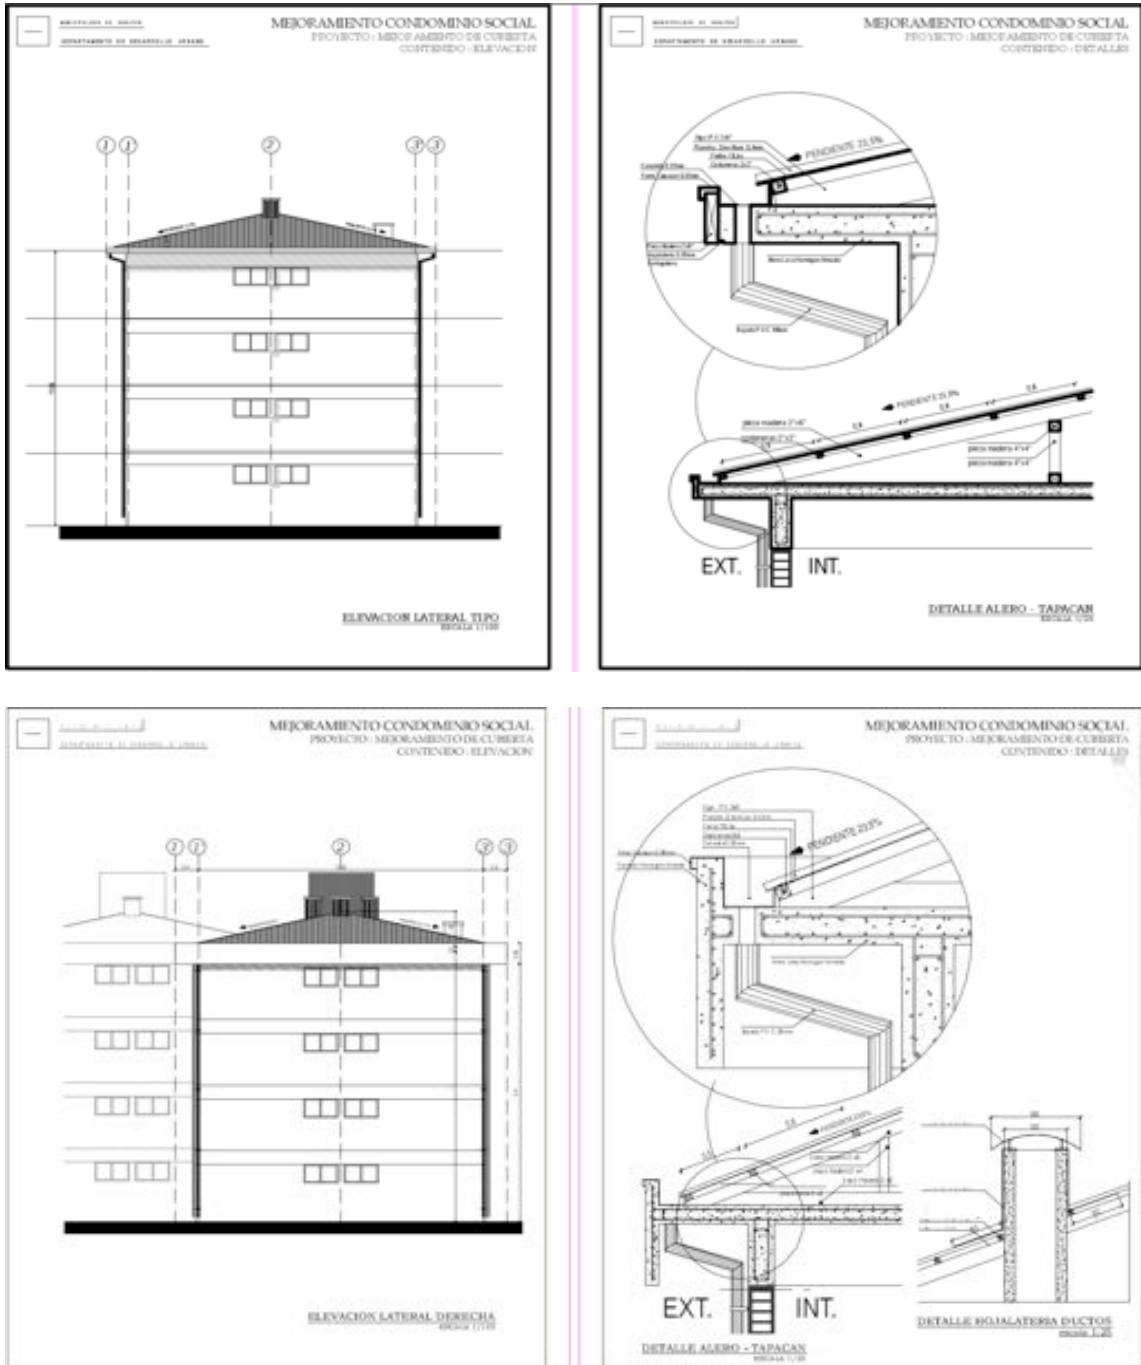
Block tipo 1010 detalles constructivos de tipos de aleros de H.A y alero simple de cerchas proyectadas. Fuente: Elaboración propia.
